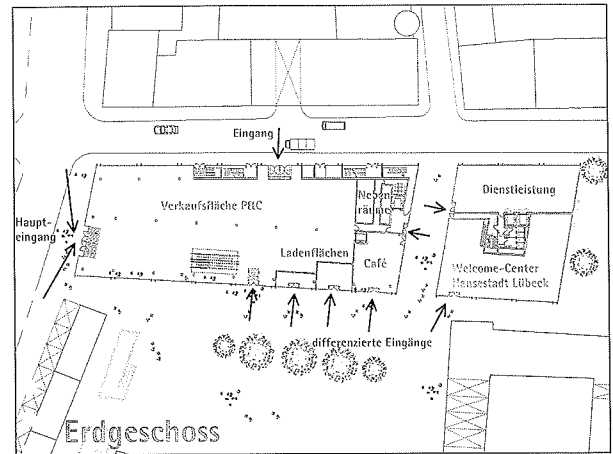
Lübeck. Markt, Neuüberbauung, genehmigtes Projekt, Grundriss Erdgeschoss. Ingenhoven, Overdiek & Partner, 2001.
